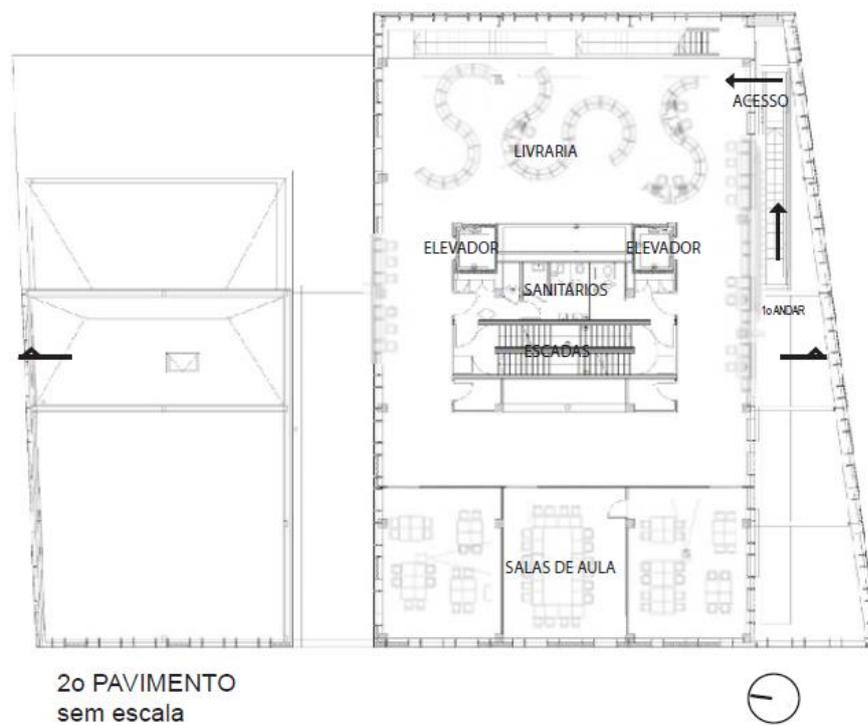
Planta do Segundo Pavimento da *Idea Store Whitechapel* (LI, 2013)
